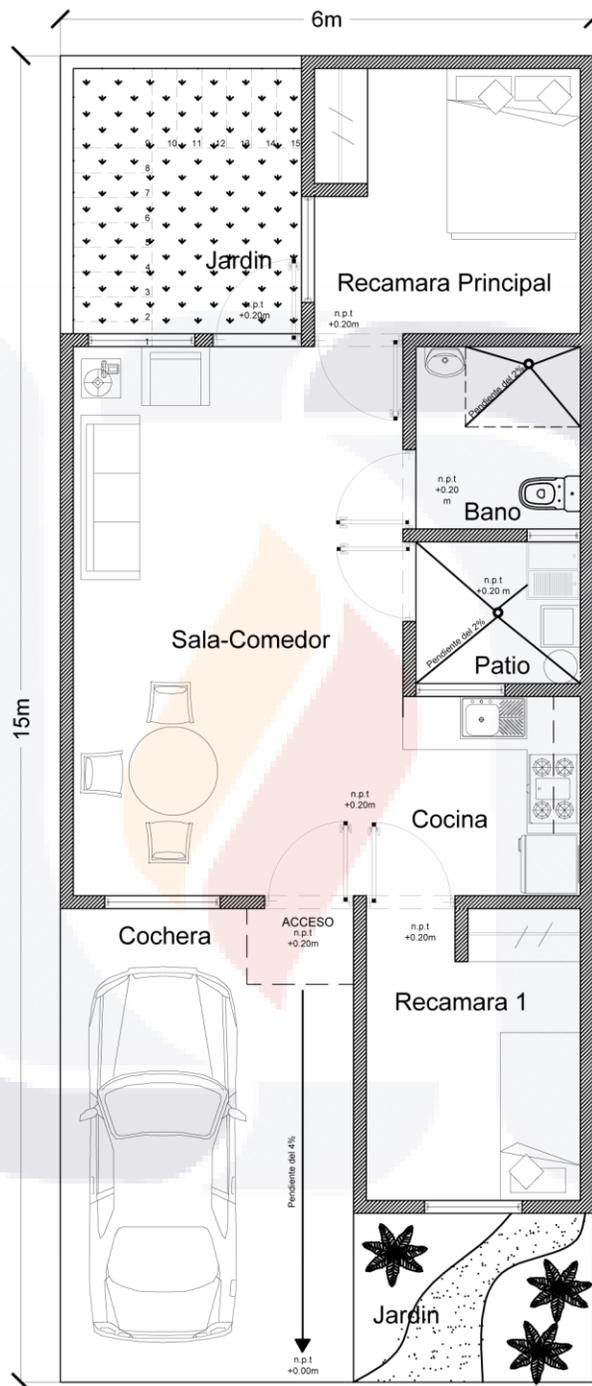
Planta arquitectónica del anteproyecto de vivienda de interés social con accesibilidad.
